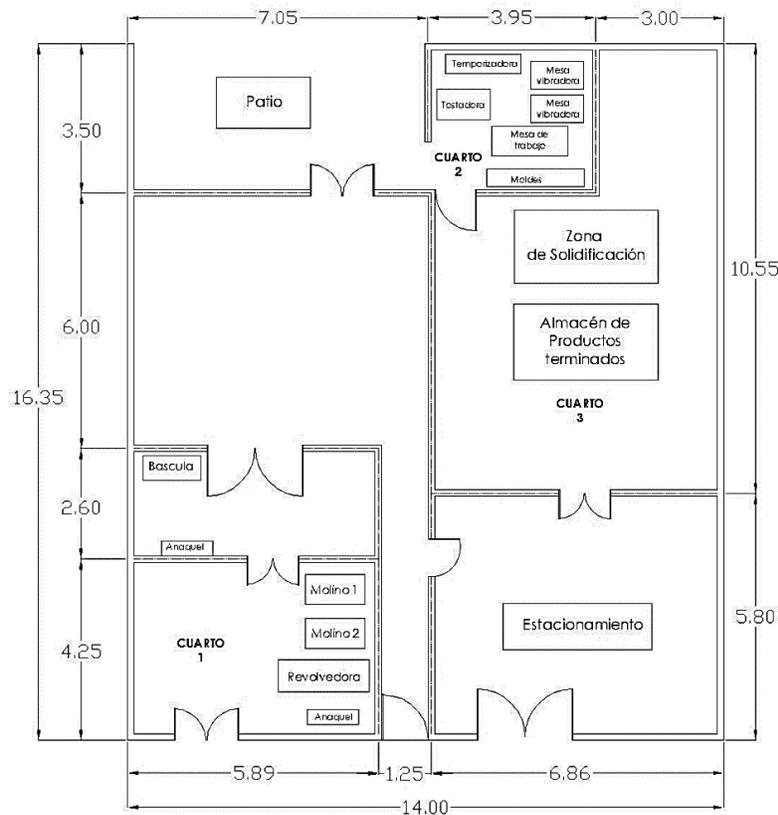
Distribución de planta actual en metros (Fuente: Tesista).
